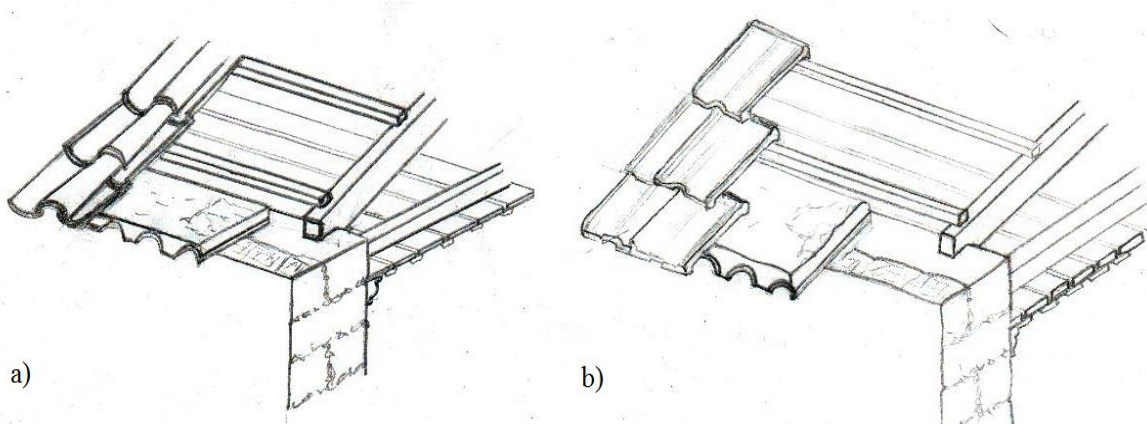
Exemplos de soluções construtivas para beirados: a) beirado executado com telha cerâmica do tipo canudo; b) beirado em telha cerâmica do tipo "Marselha". (Fonte: de autor)
